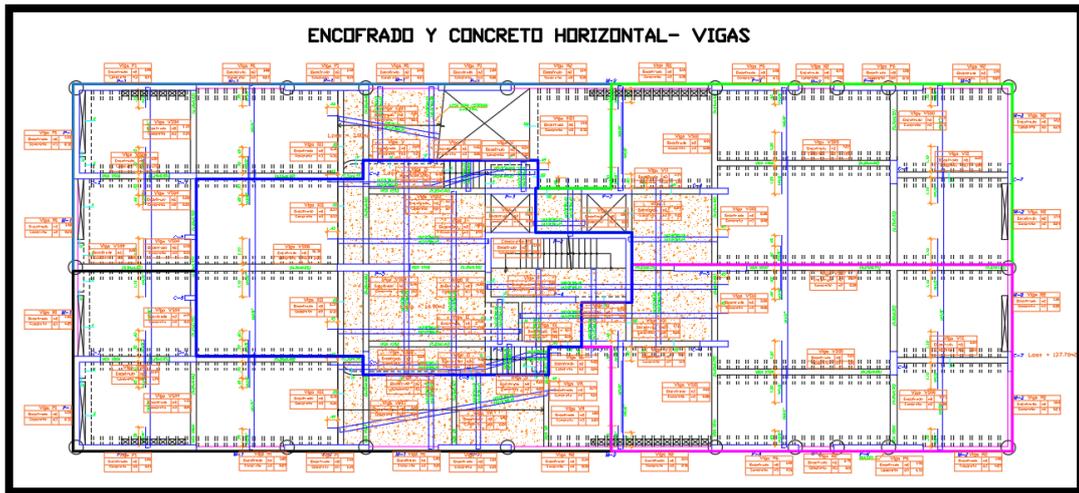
Sectorización de Elementos horizontales para encofrado y vaciado de Concreto – Sótano
